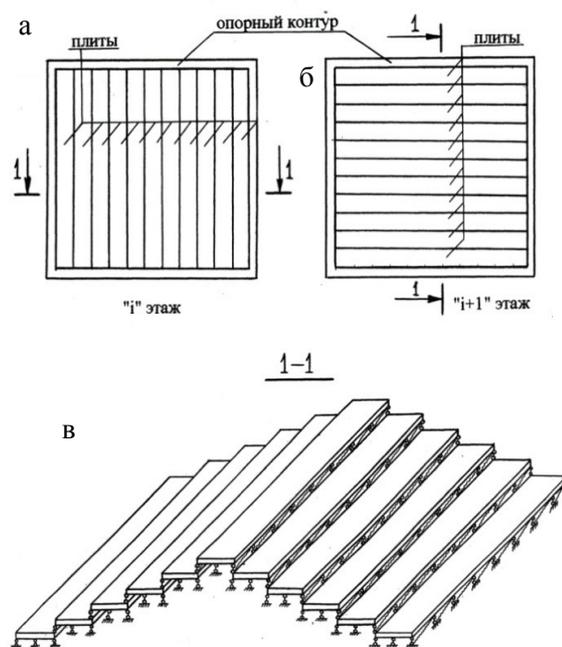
Расчётная схема диска перекрытия: а, б – компоновка диска перекрытия; в – этажная схема
